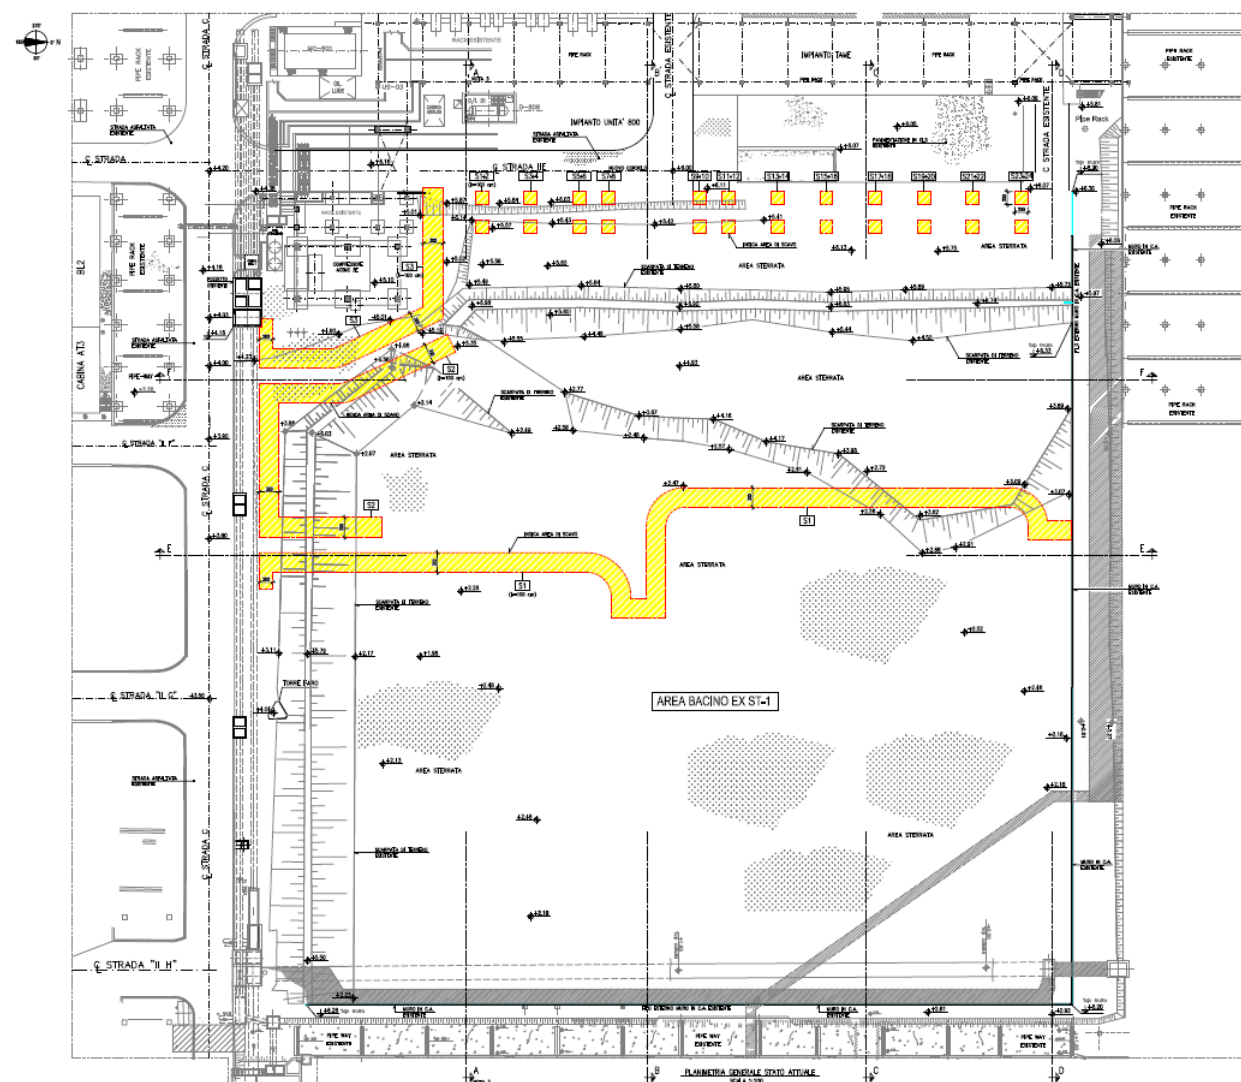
planimetria stato attuale con indicazione degli scavi in giallo
